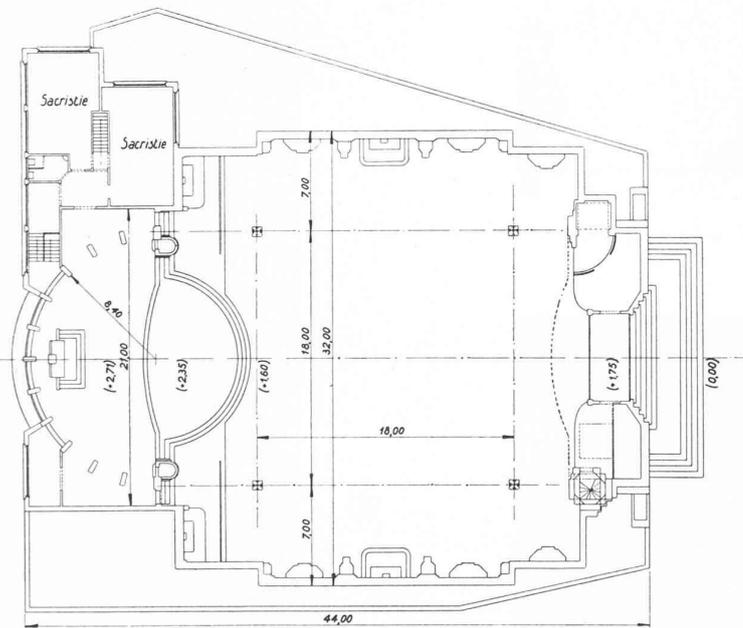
Plancher au-dessus du niveau du pavement du chœur.
